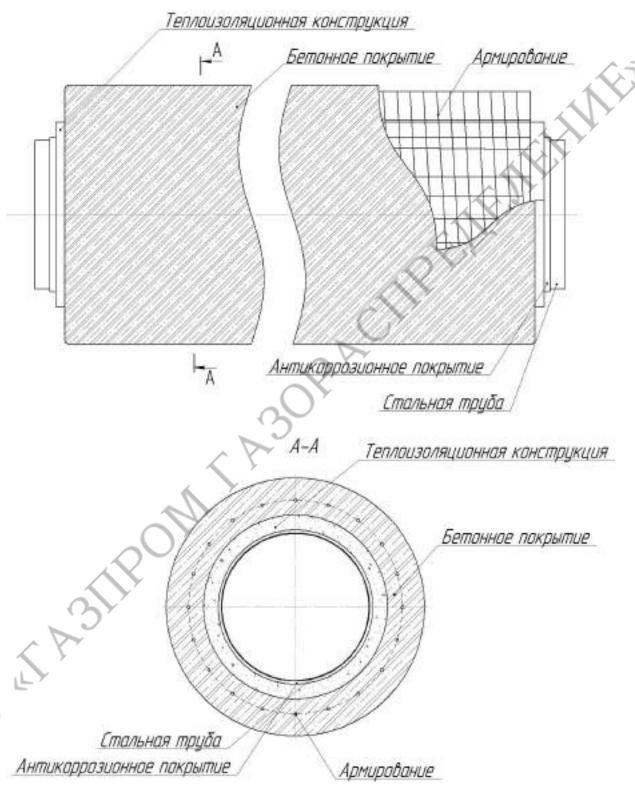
Труба с антикоррозионным покрытием, теплоизоляционной конструкцией и наружным утяжеляющим бетонным покрытием
